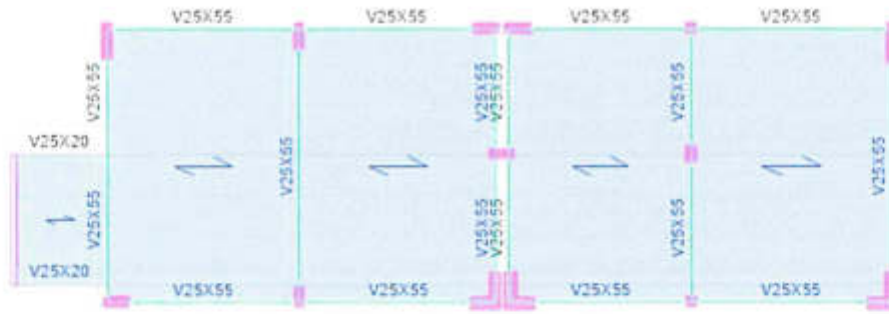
Planta Primer y segundo nivel con losa aligerada
